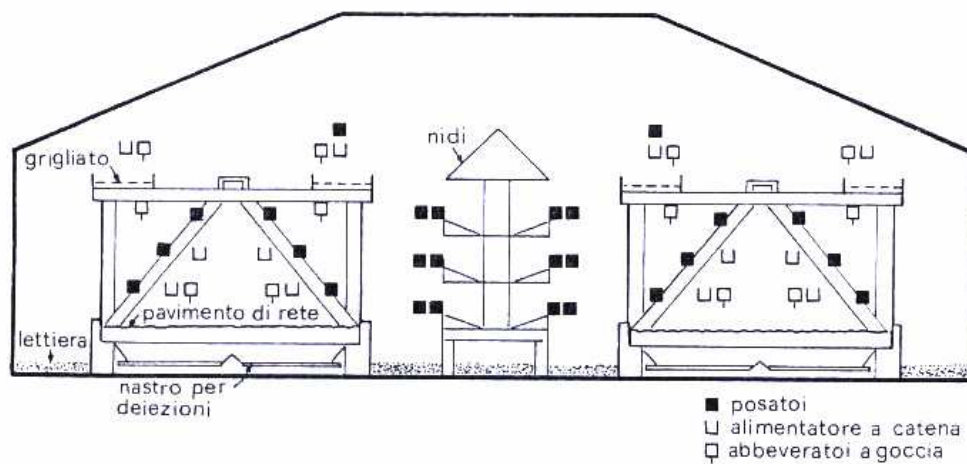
Schema di pollaio con pavimento in rete a piani sovrapposti (Tiered-wire-floors). Al centro e ai lati del capannone sono collocati i nidi; il pavimento è ricoperto in lettiera (Meluzzi, *et al.* 1989).
